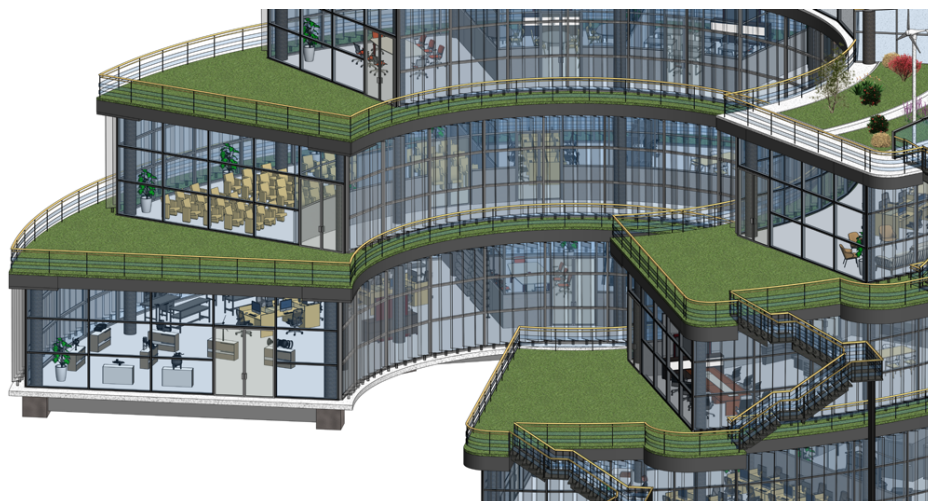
Cubiertas ajardinadas extensivas en primera y segunda planta. Modelo en Revit.
